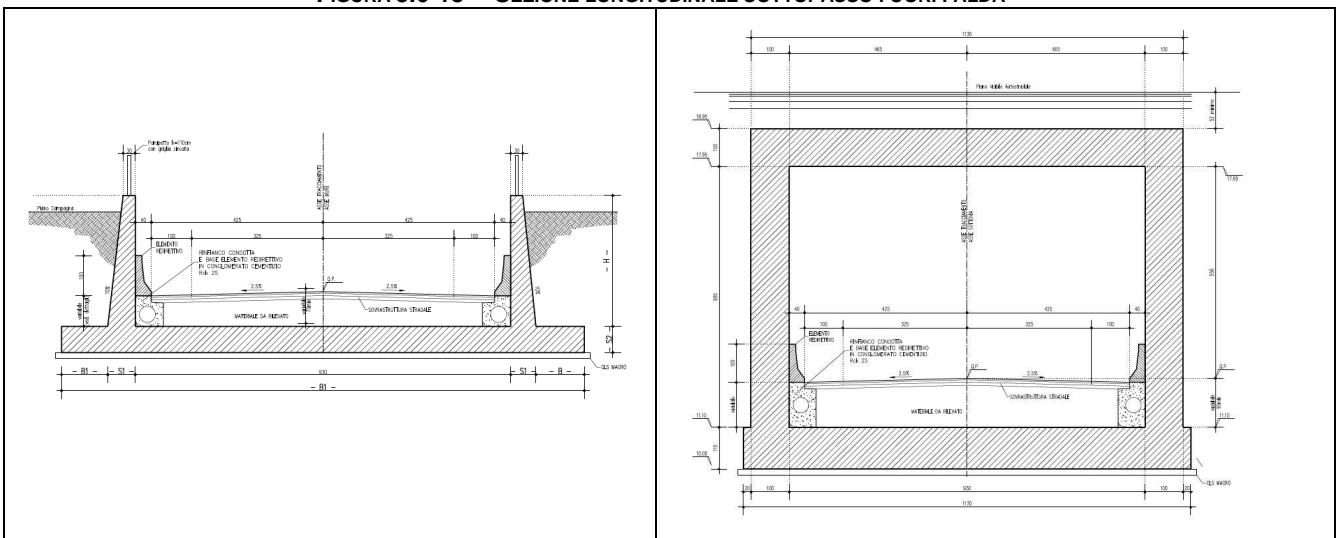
SEZIONE TRASVERSALE TRINCEA CON MURI AD U E MANUFATTO SCATOLARE (IN FALDA)
